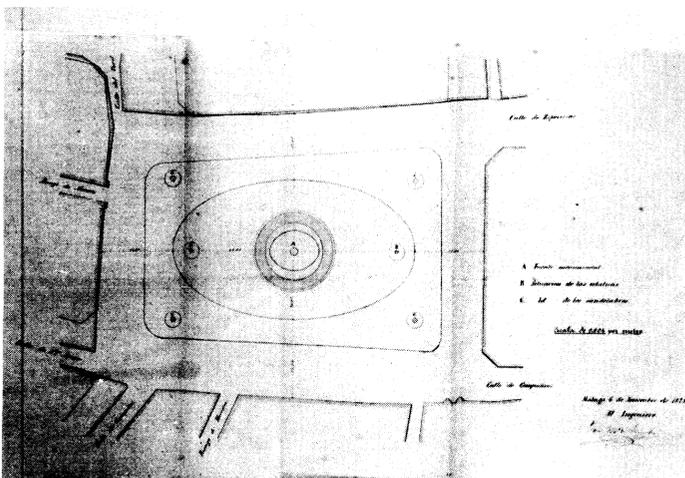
Plano de planta de la remodelación de la plaza de la Constitución. José María de Sancha, 1878.
